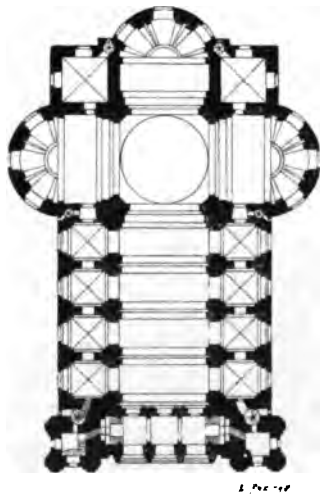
Grundriss des Doms zu Salzburg
